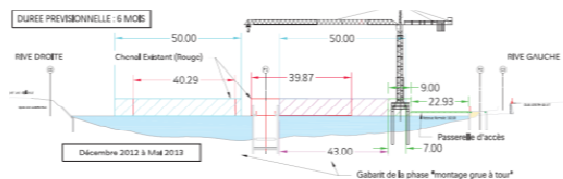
Coupe de l'installation de chantier lors de la phase de travaux sur P1
